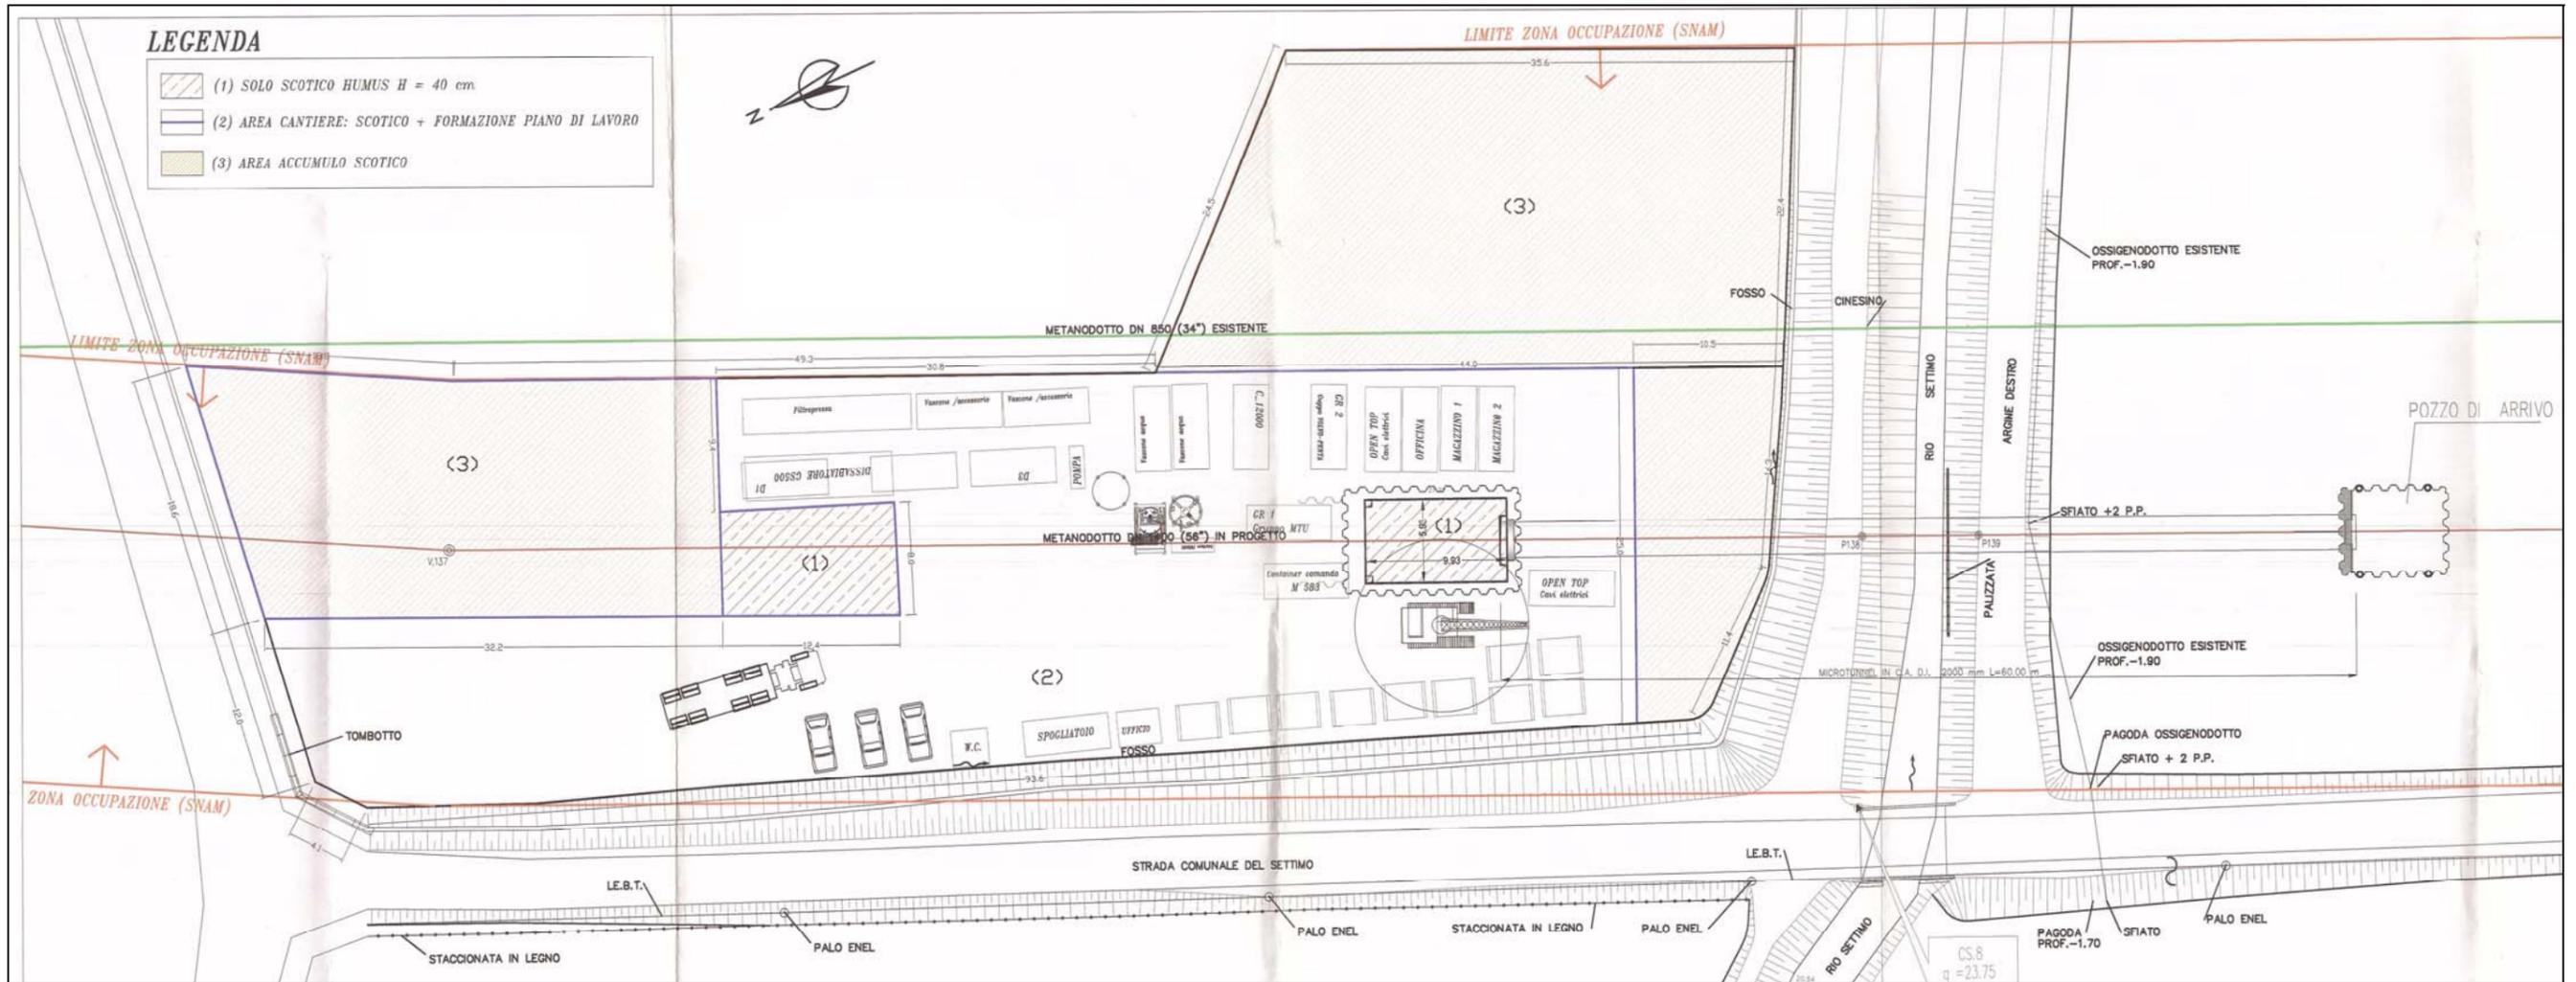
/E: Planimetria cantiere microtunnel - Esempio
